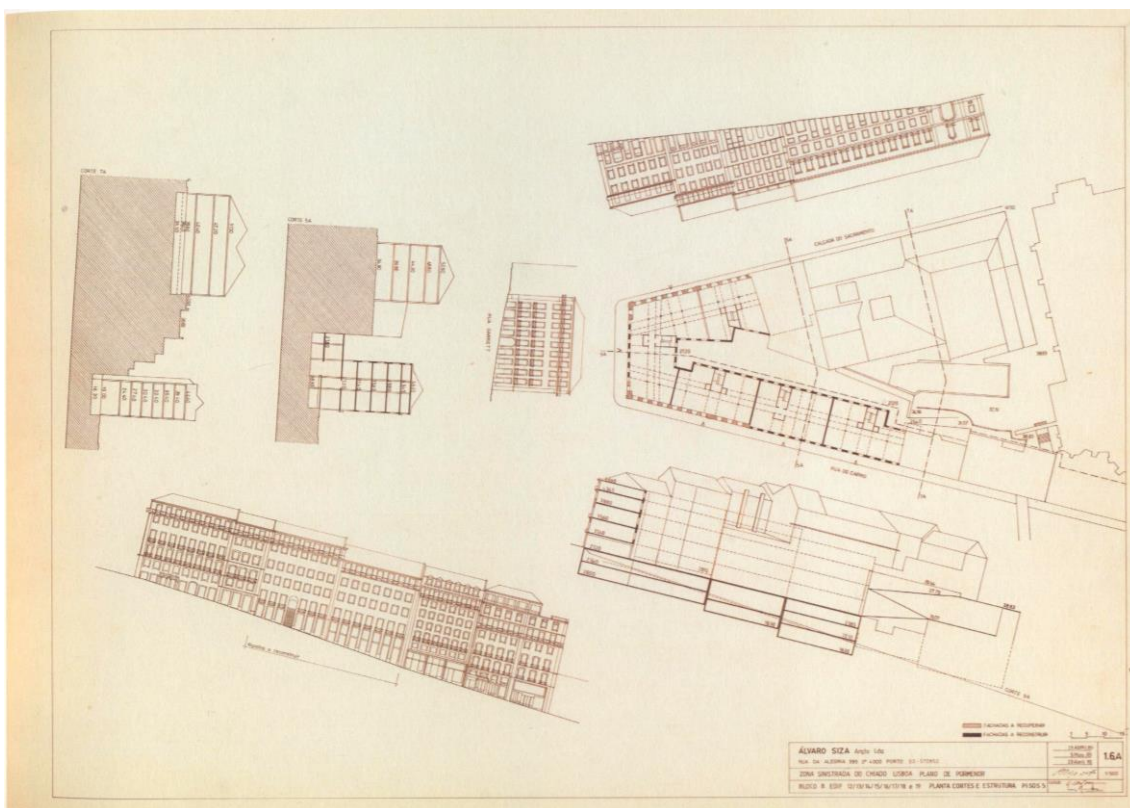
VIEIRA, Siza, *Reconstrução da zona sinistrada do Chiado*, Lisboa, 1988/98. Plano de Pormenor- bloco B. Planta, cortes e estrutura, pisos 5. Desenhos sem escala.
